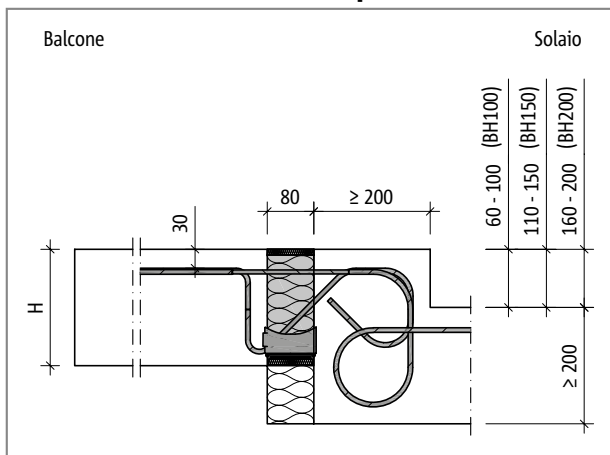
Schöck Isokorb® T tipo KL-BH: balcone con innalzamento e isolamento esterno
